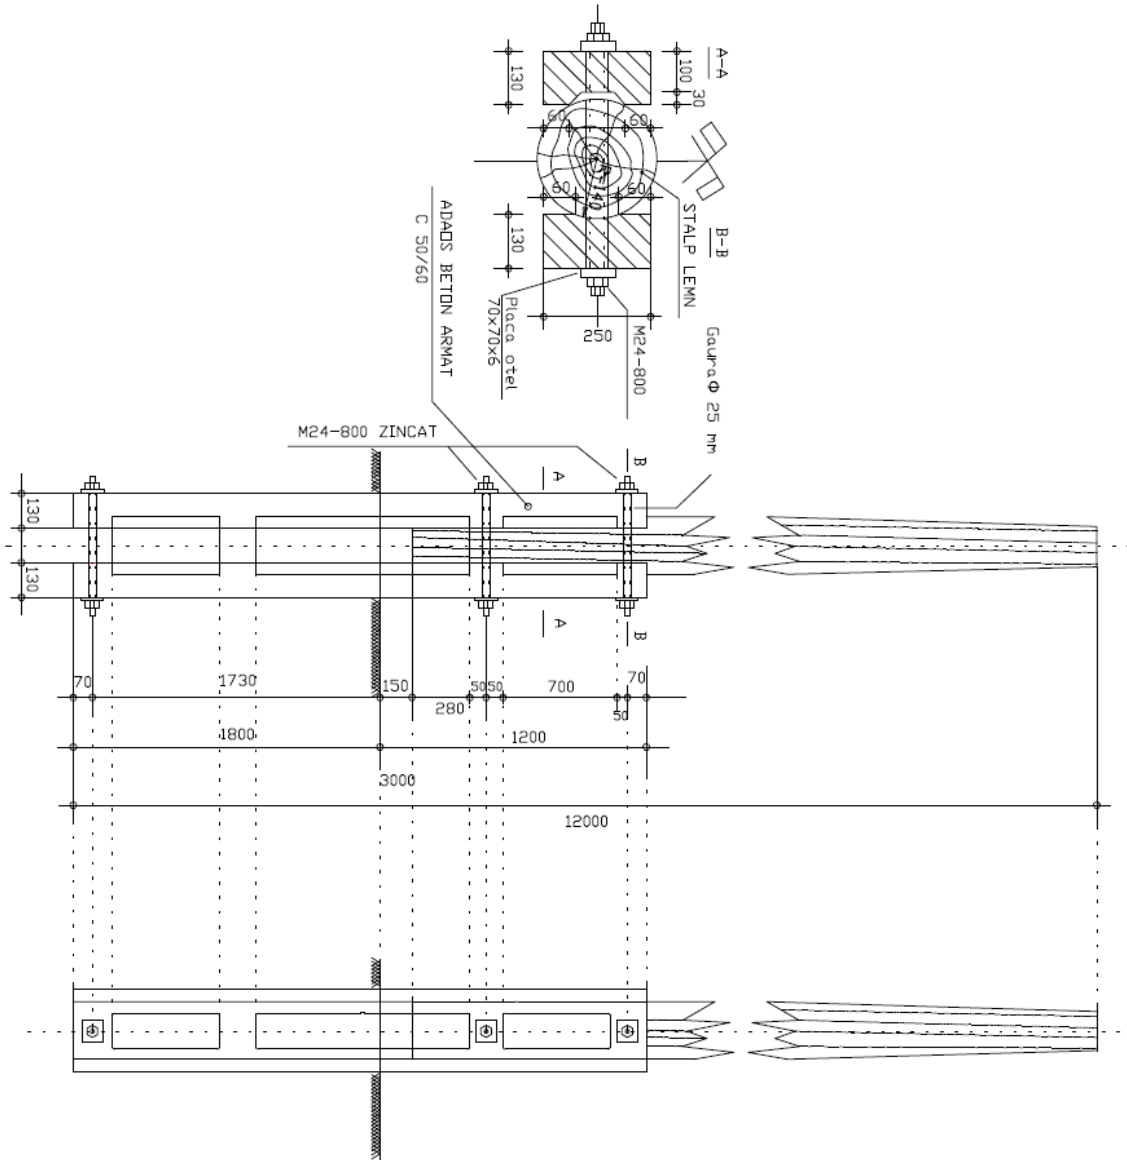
Detaliu îmbinare stâlp de lemn cu 2 adaosuri de beton
